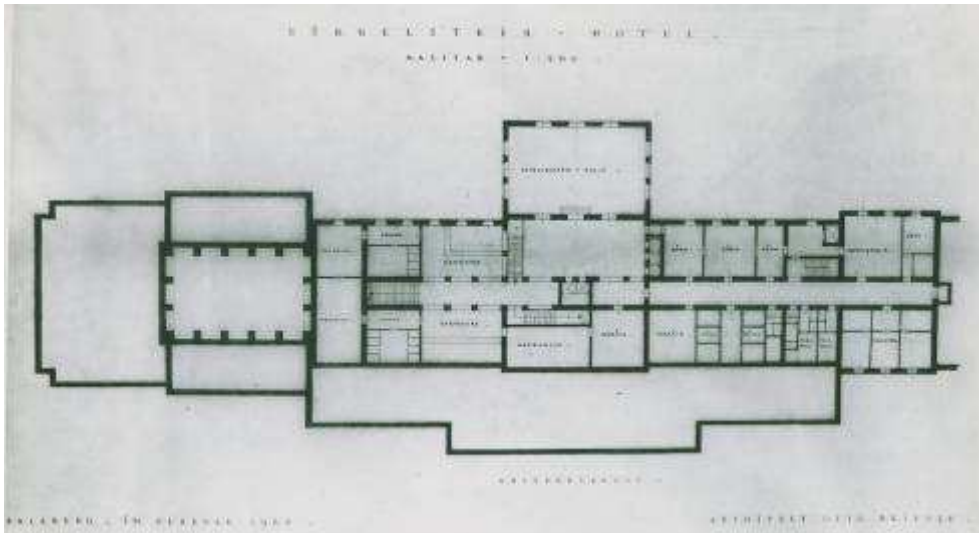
Otto Reitter, Grundriss, Untergeschoss, *Bürgelstein-Hotel*, Salzburg, Februar 1943 (Sammlung Ostheim).
